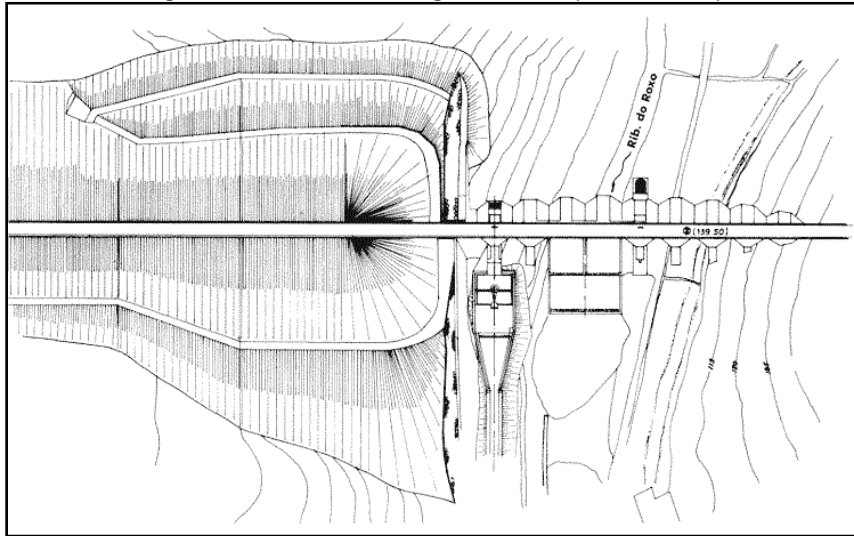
Alçado da Barragem do Roxo (CNPGB, 2008)
